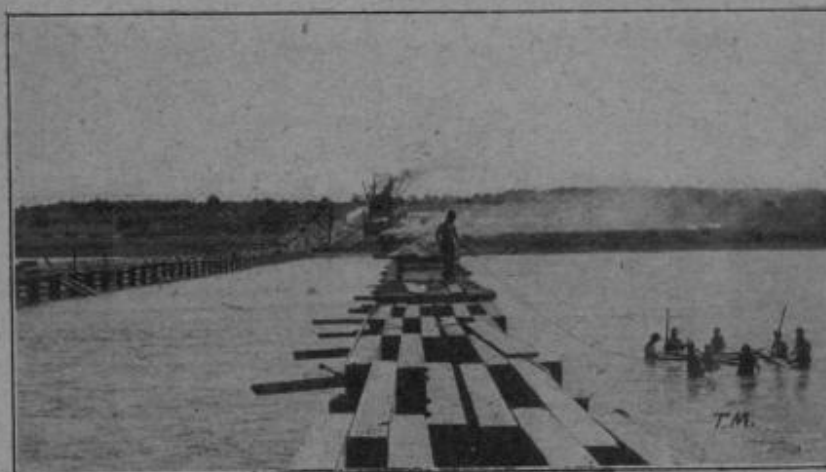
Usine de Keokuk. — Établissement et mise en place des batardeaux pour la construction du barrage.
